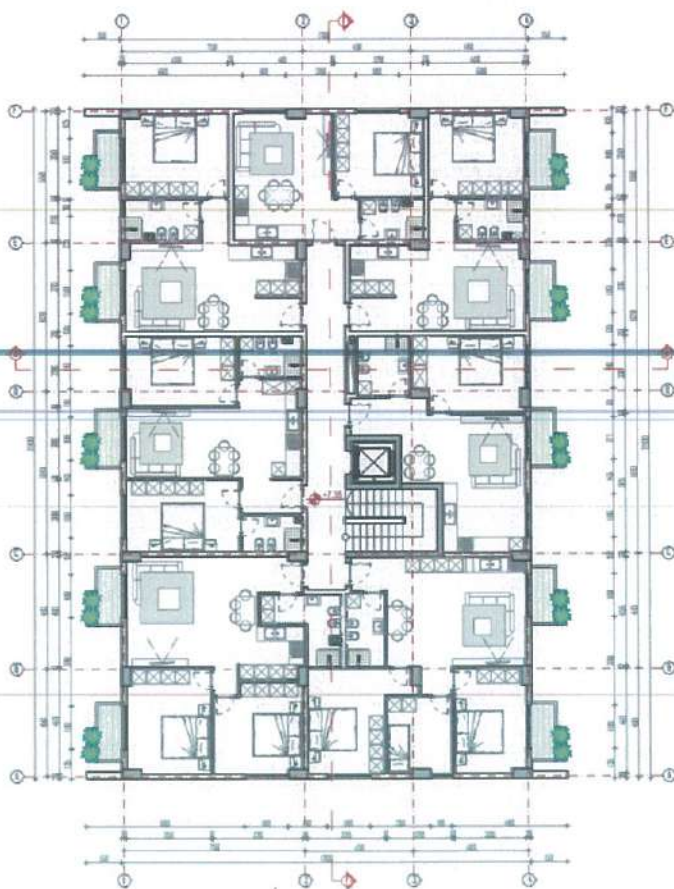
Planimetria e katit të dytë & katërt, objekti 1 & 2
